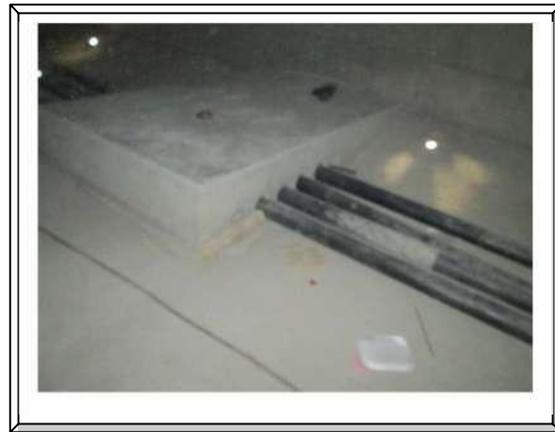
Desviadores a nivel de losa de fondo P2-P3.
